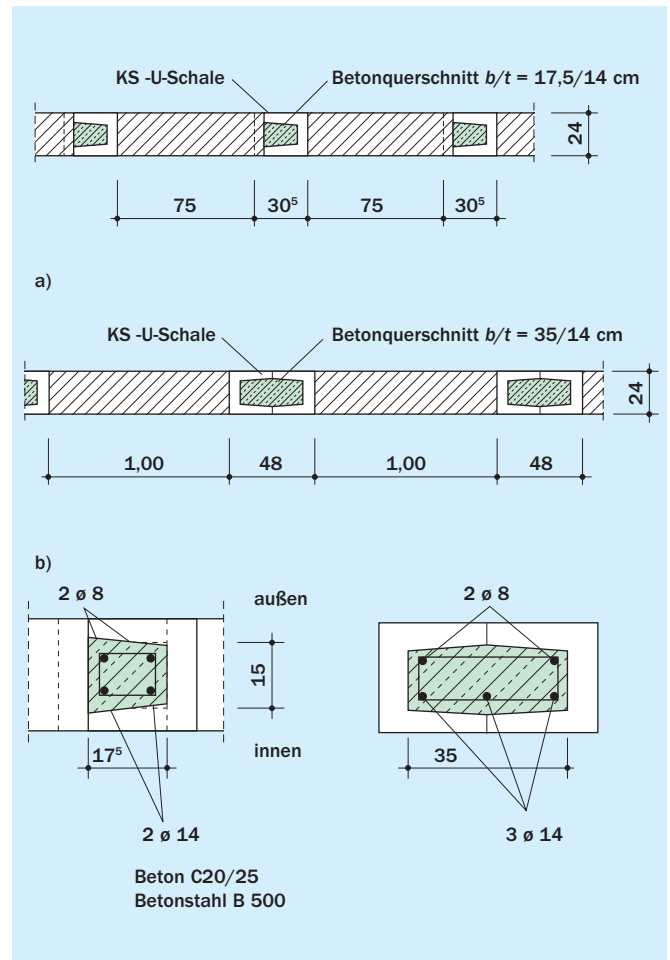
Aussteifende Stahlbetonstützen unter Verwendung von KS-U-Schalen
